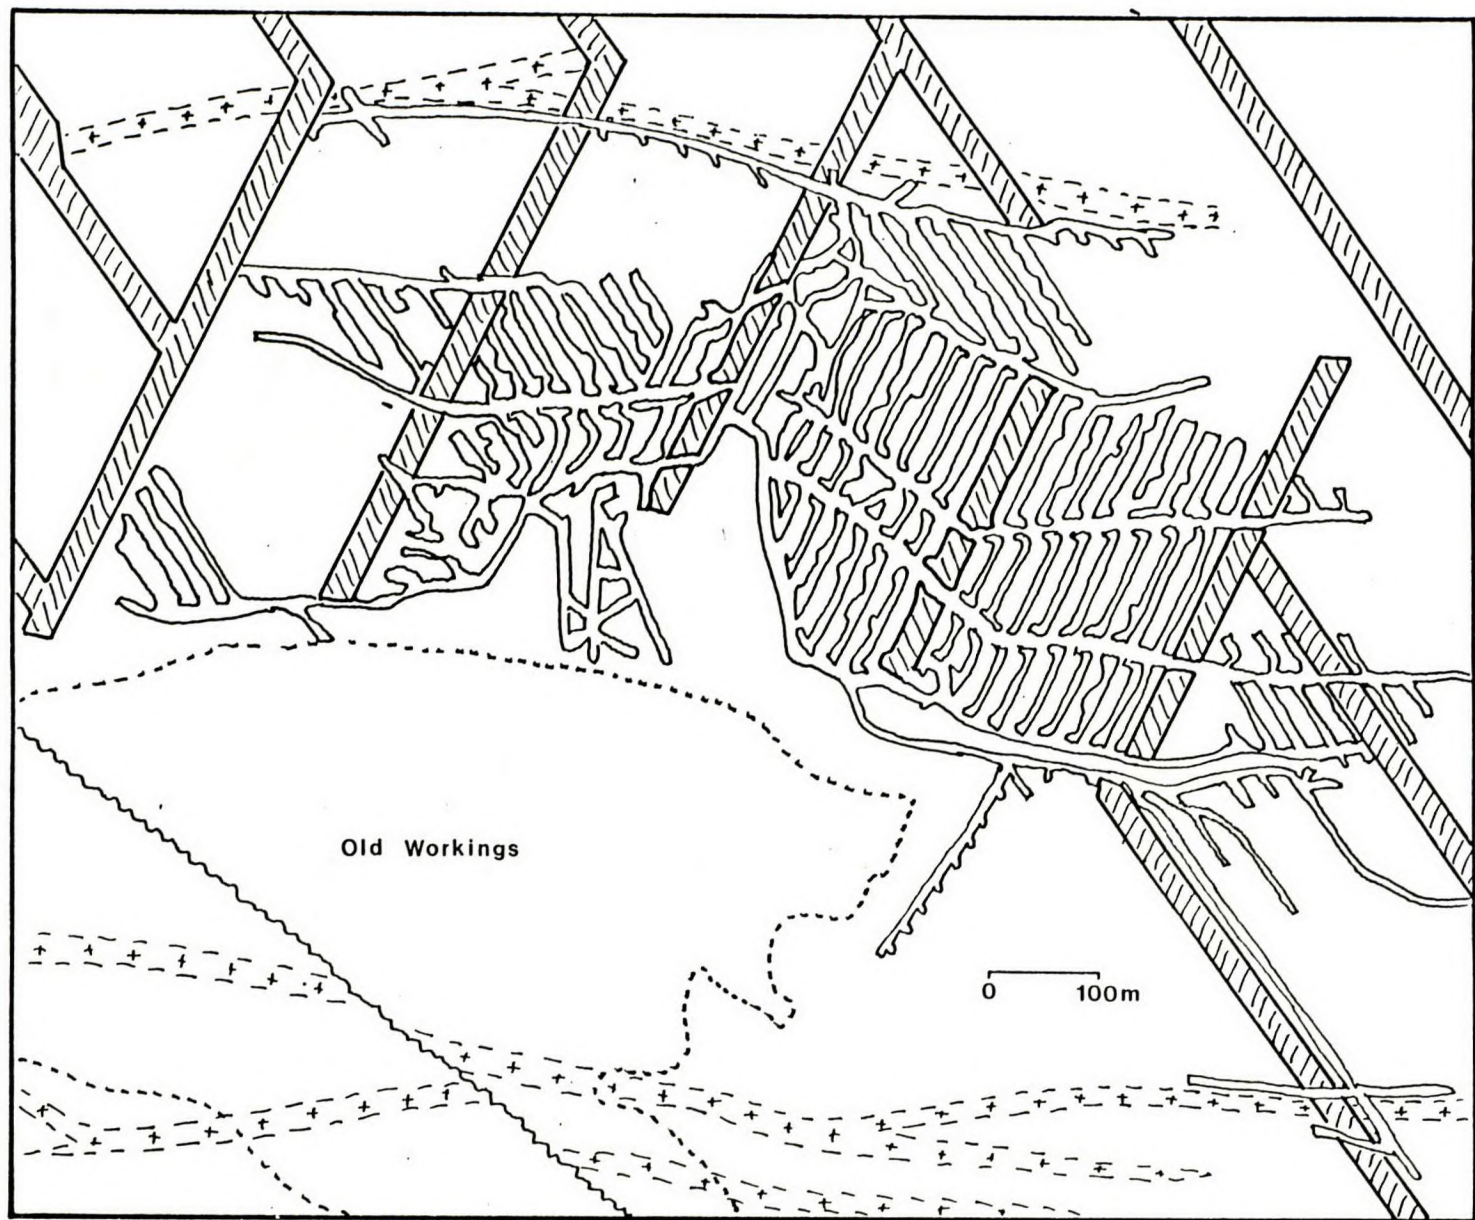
Plan de piliers stabilisateurs d'une mine profonde d'uranium d'Elliot Lake.
